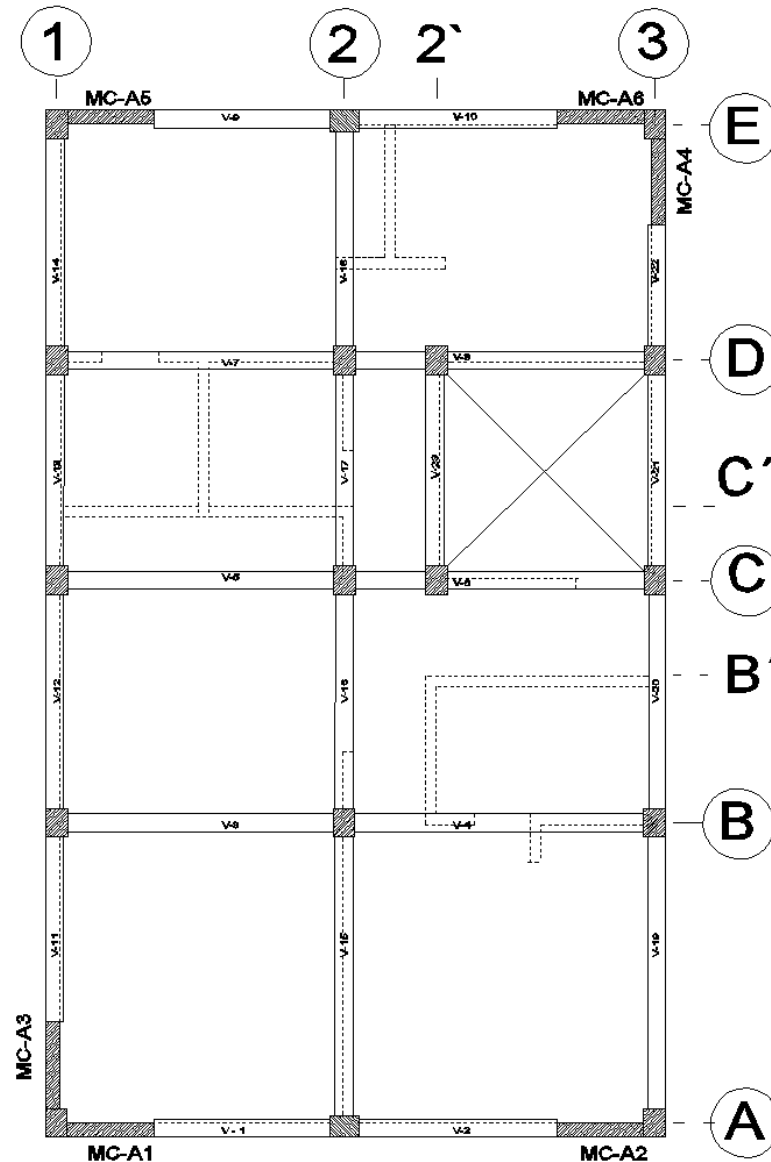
PLANO DE VIGAS – DUAL TIPO I
